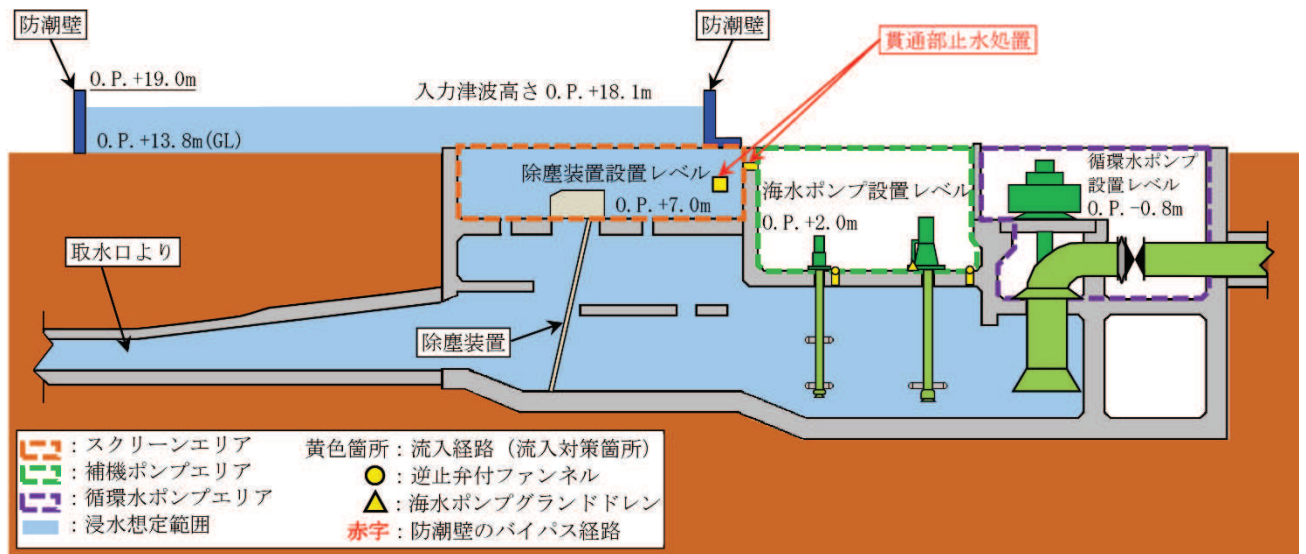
第 2 号機 海水ポンプ室 流入対策配置図 (A-A 断面図)
